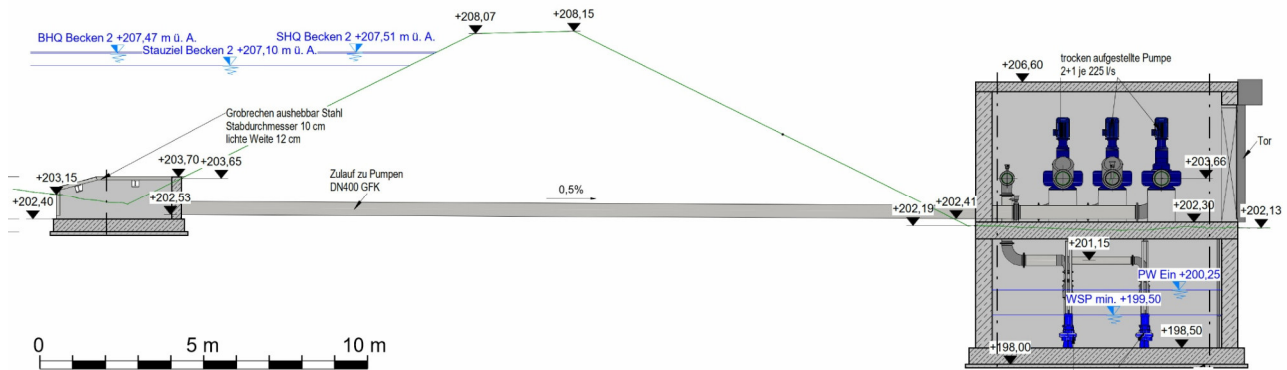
Schnitt durch Einlaufbauwerk, Rohrleitung und Pumpwerk (Quelle: Einlage 030)
